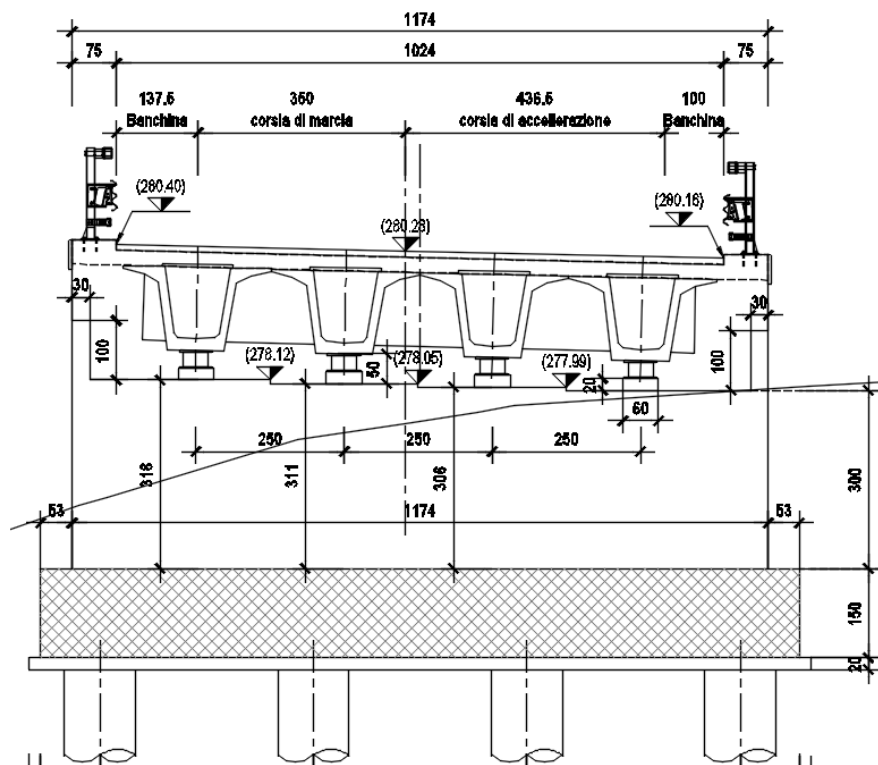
Sezione su spalla del ponte inizio lotto.
